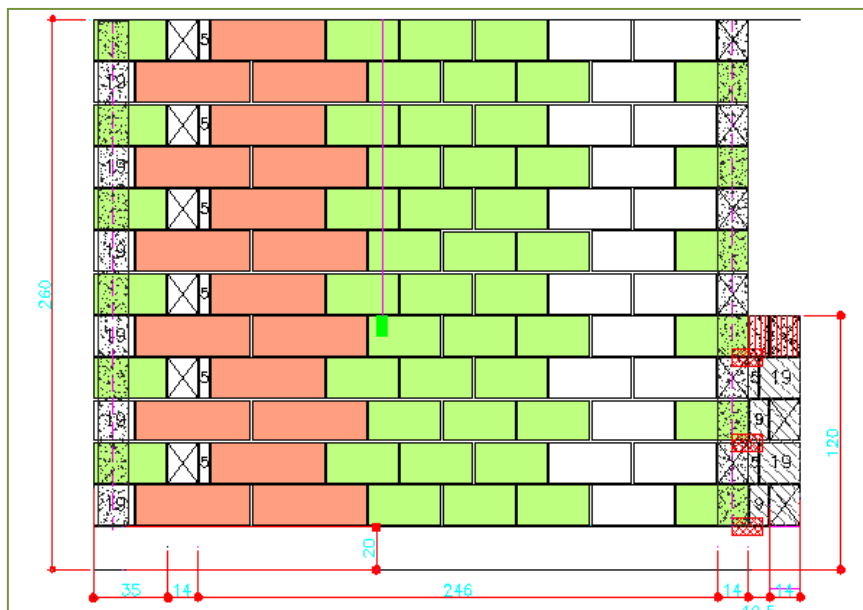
Elevação de uma parede do Projeto de Racionalização das Alvenarias
